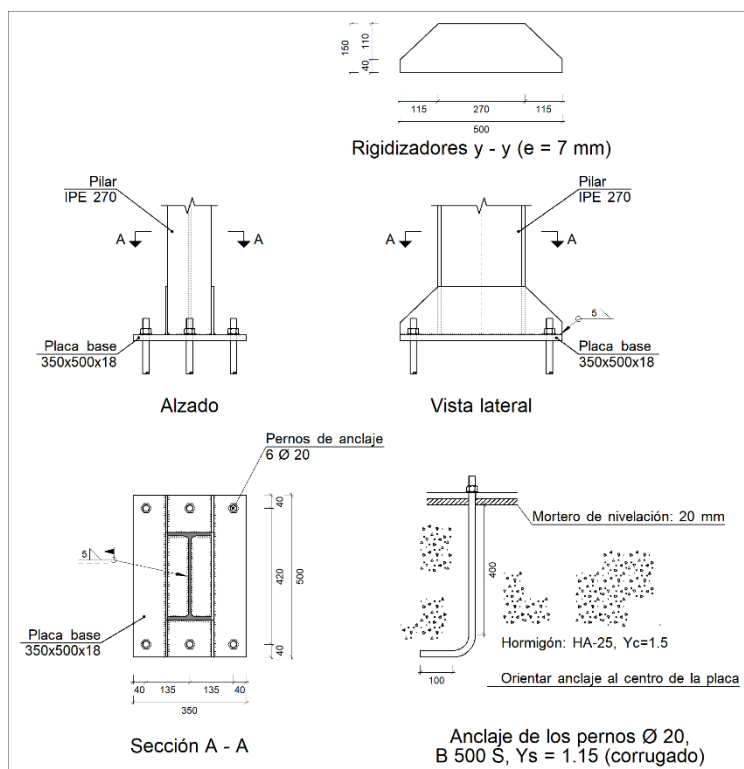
A. Detalle placa de anclaje tipo 2, del pórtico de fachada. (CYPE 3D)
